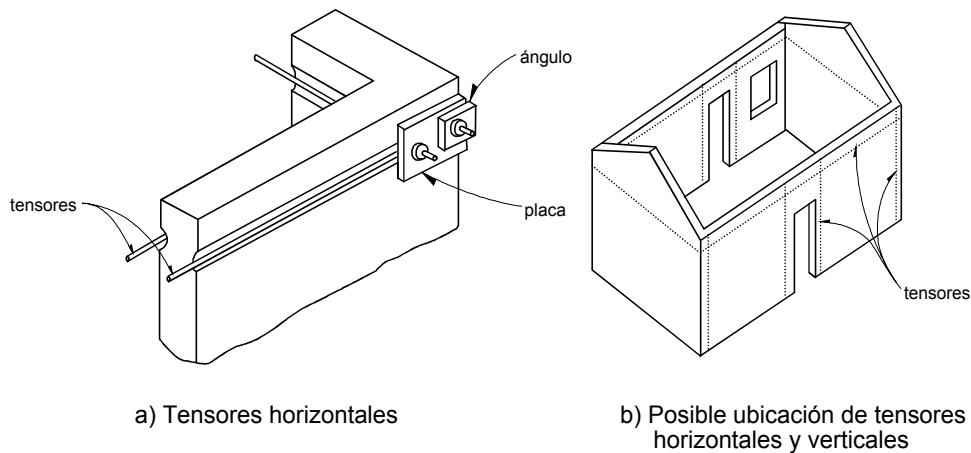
Amarre de muros de adobe con tensores metálicos
